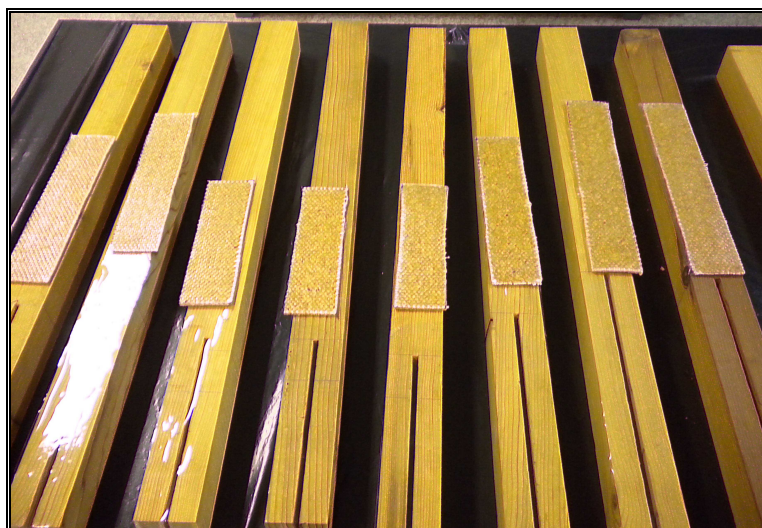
Vigas y placas de refuerzo preparadas para aplicar la resina epoxi (1).
